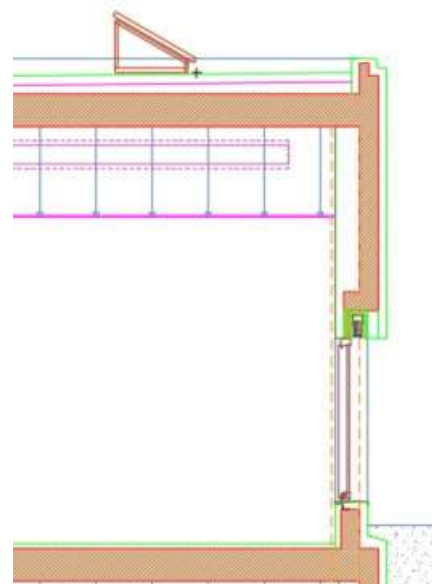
Fachadas - vãos envidraçados (corte).
